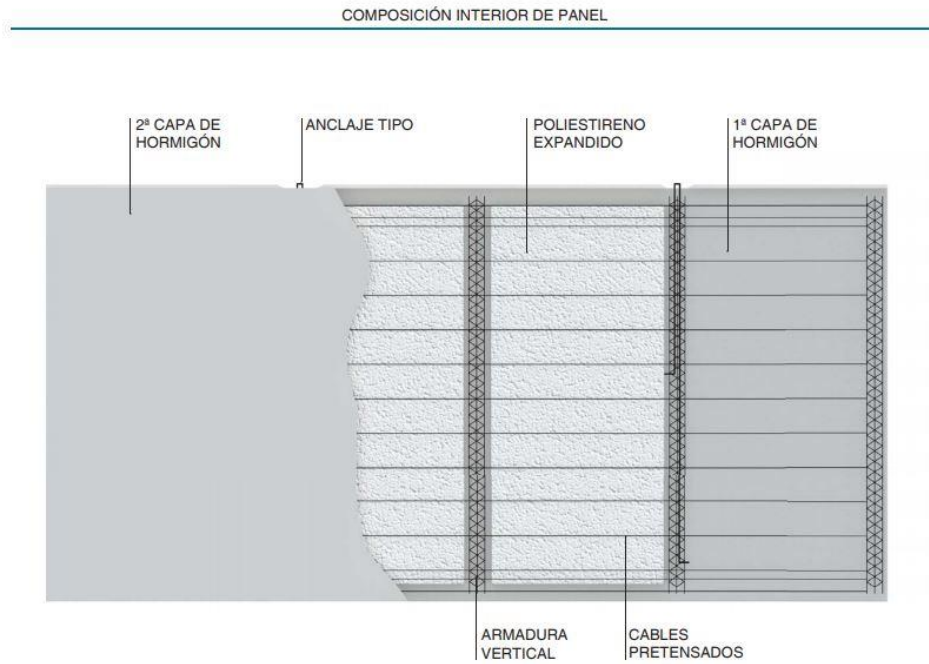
Alzado cerramiento de panel de hormigón prefabricado.
